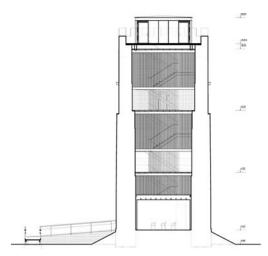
Sección con vista de la nueva escalera interior. Dibujo de los autores
